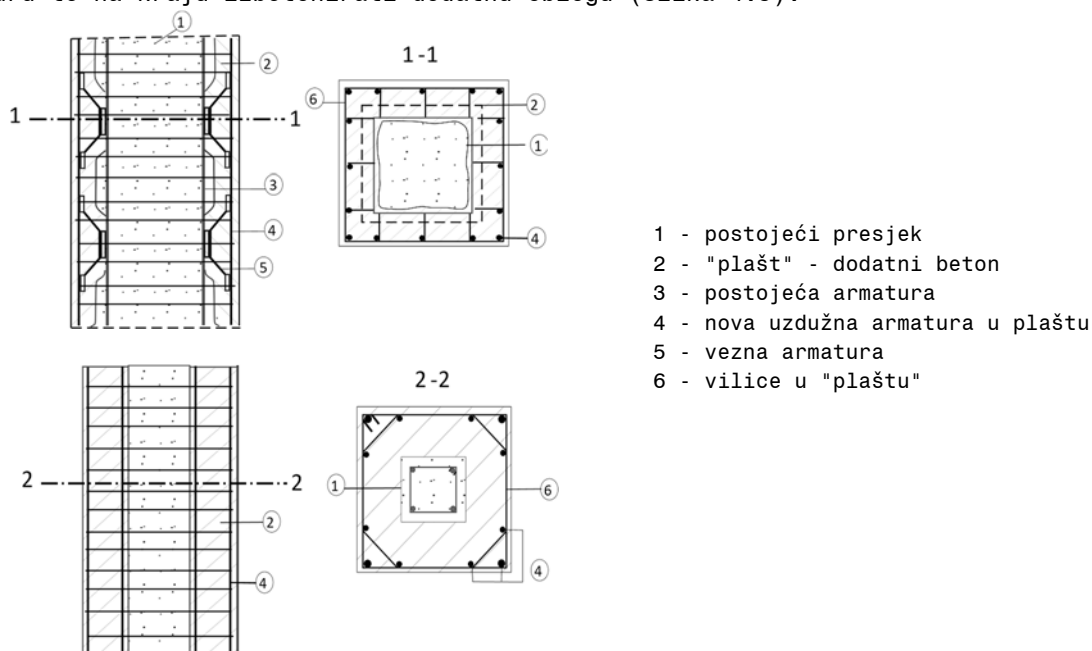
Lokalno saniranje stupova za dublja oštećenja
